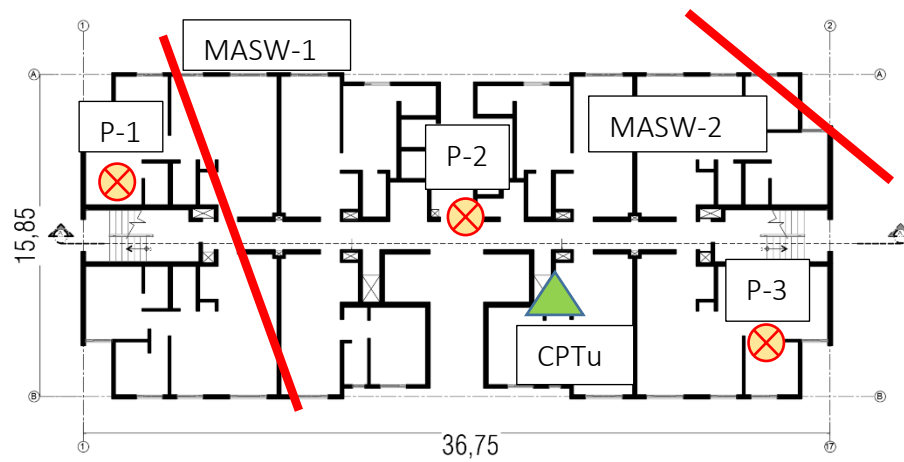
Planta del edificio de apartamentos con ubicación de ensayos.
